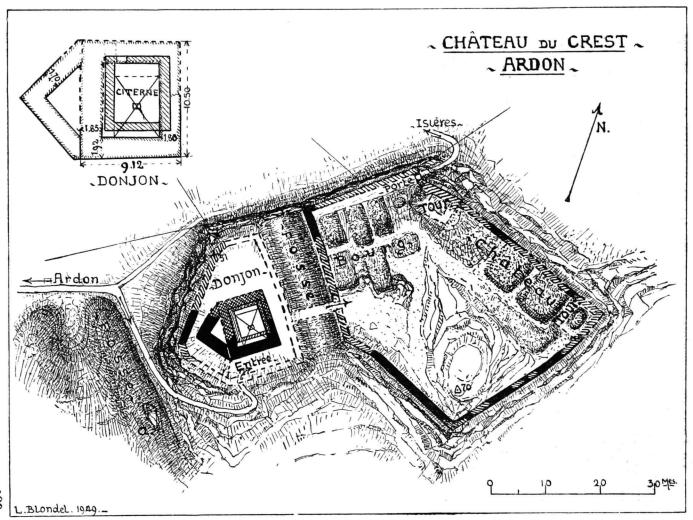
Plan général du château du Crest sur Ardon. — Détail du donjon.
